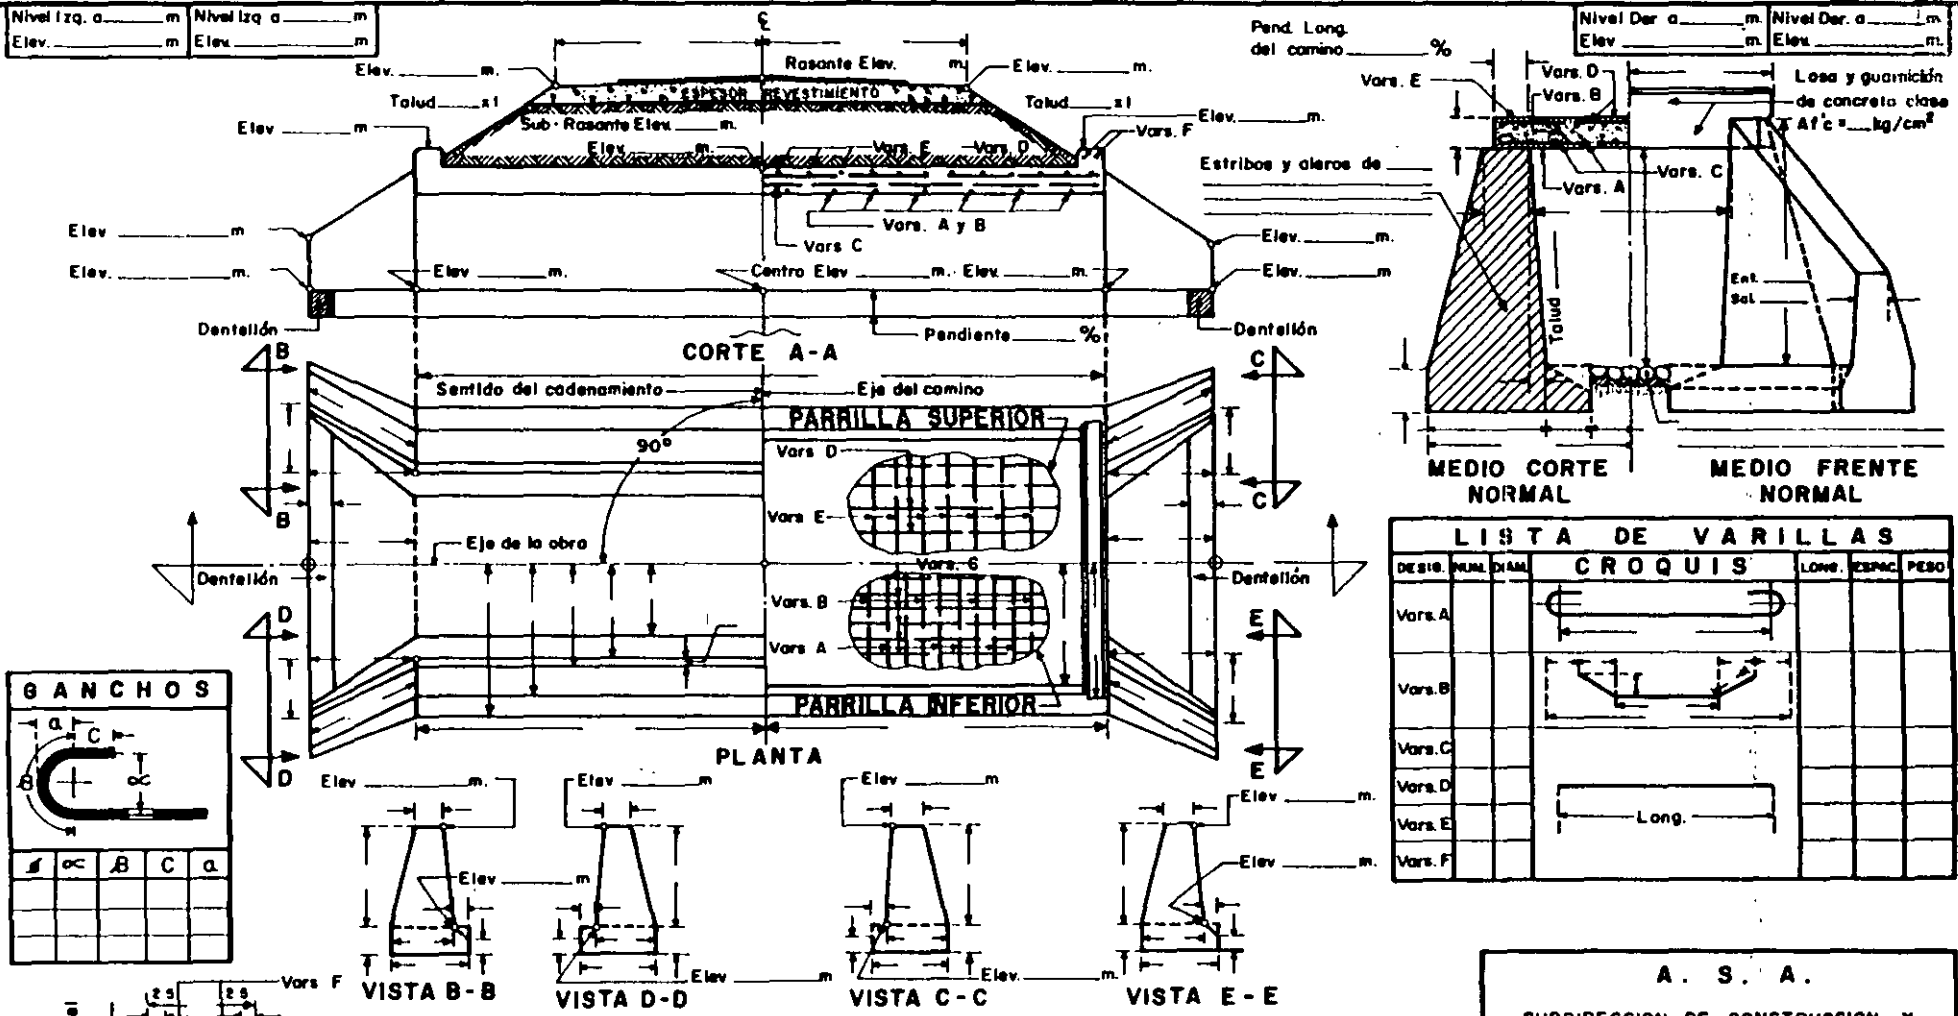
PLANO TIPO DE ALCANTARILLA DE LOSA
